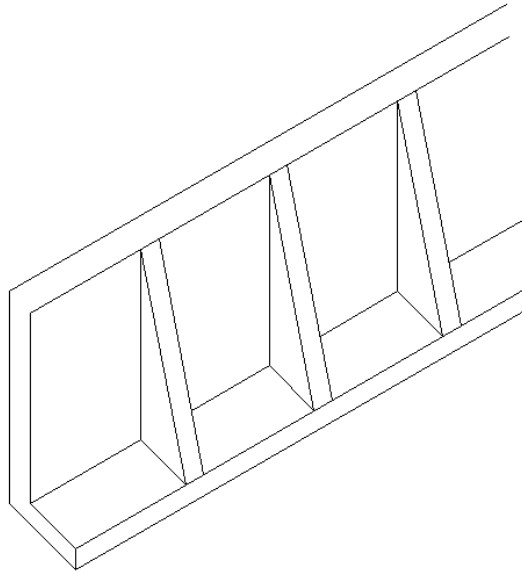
(sección isométrica de un muro de concreto en voladizo con contrafuertes)
